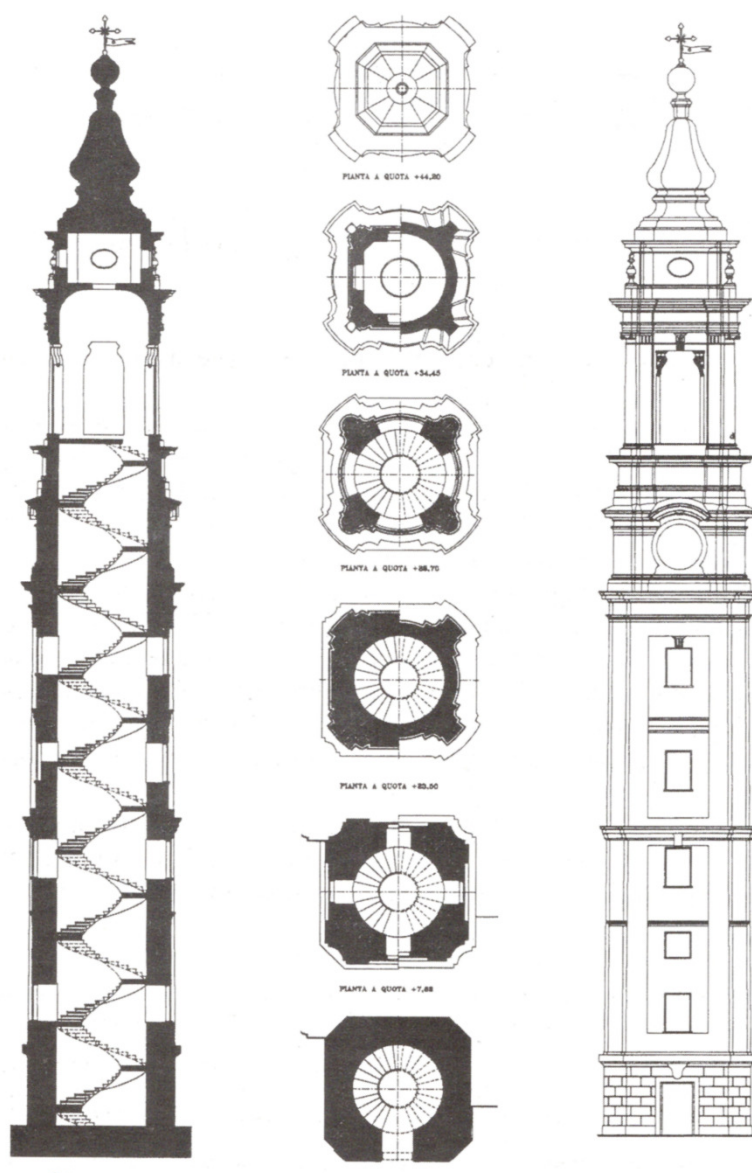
Sezione, piante e prospetto, Campanile di Vittone
